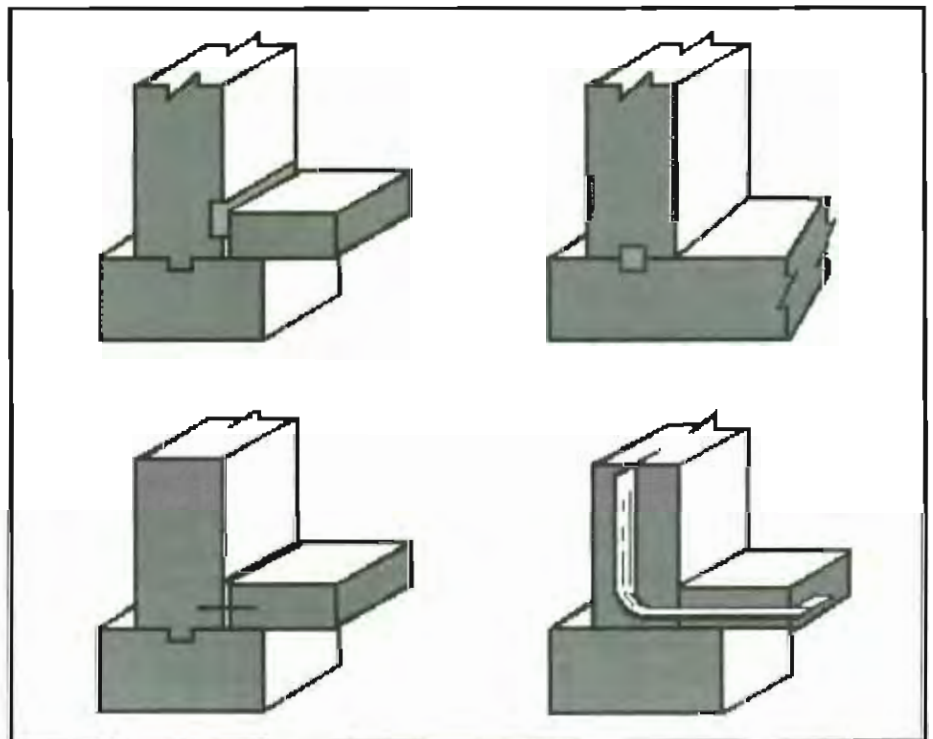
Ejemplos de Juntas y Uniones Impermeables en Estructuras
